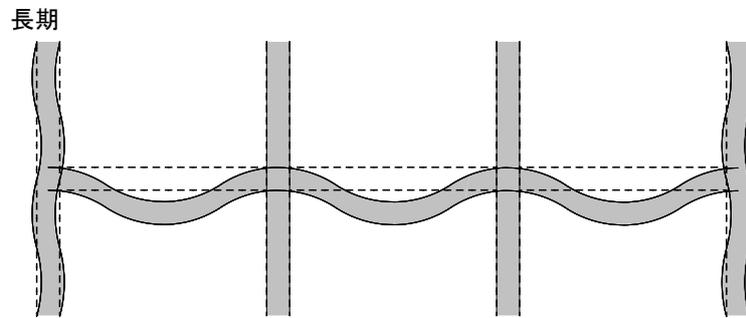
構造物の長期荷重によるたわみ（-）変形図
